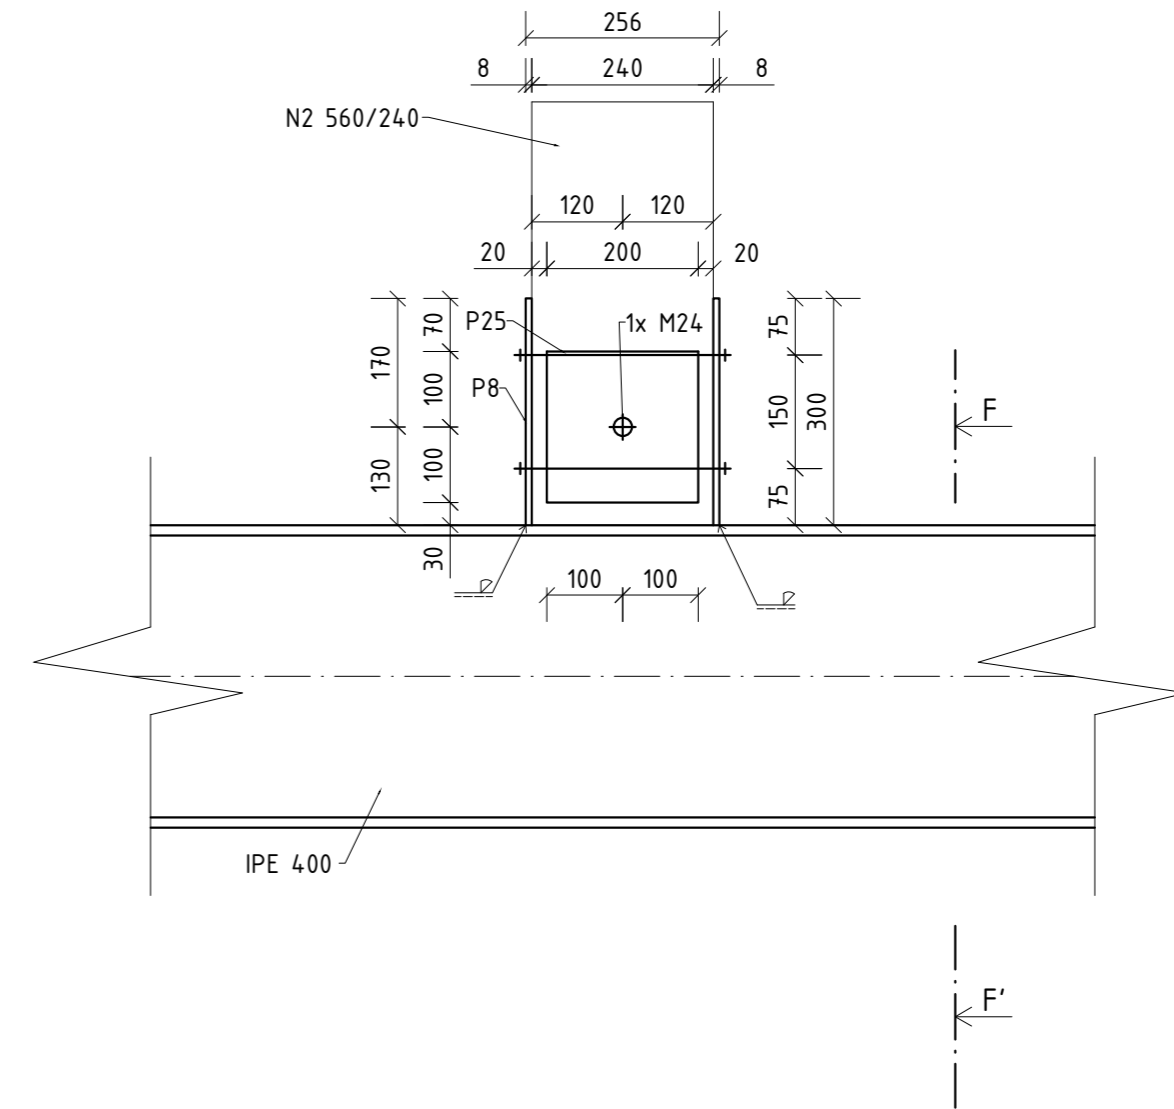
VETKNUTÁ PATKA SLOUPU
